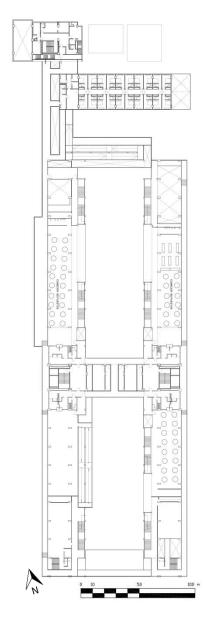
Planta segundo piso EPMSC IPIALES Fuente: elaboración propia
